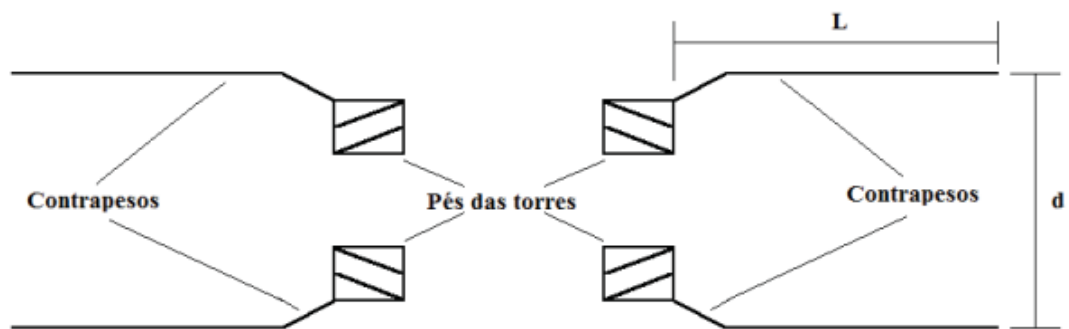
Disposição dos contrapesos (Fonte: CTEEP)
